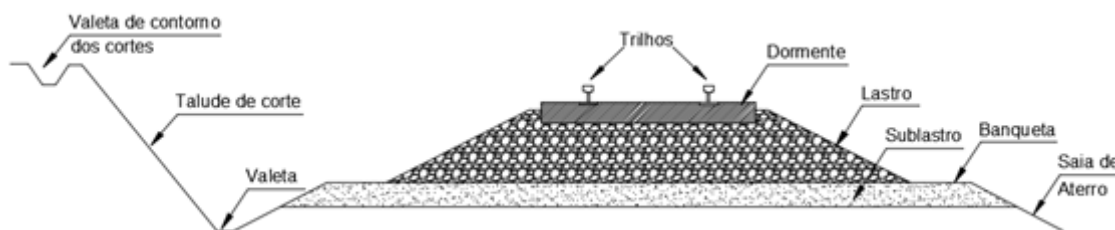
Pavimento ferroviário (Brina, 1979).
